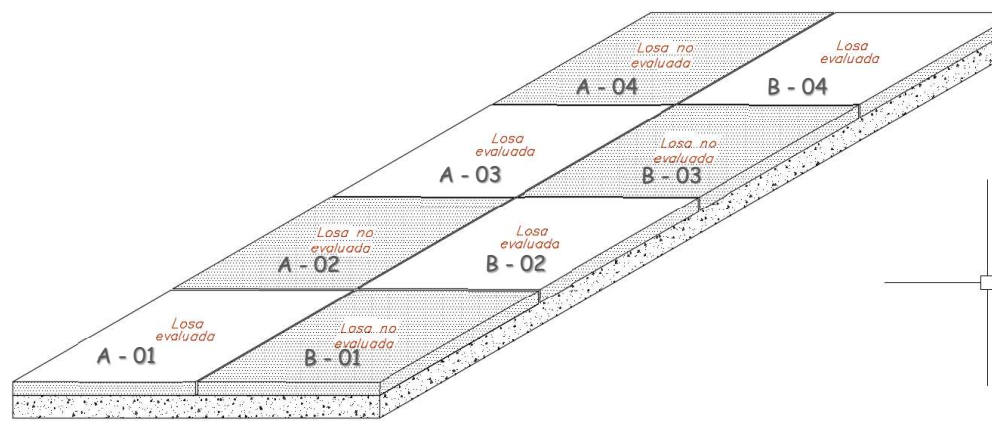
Orden de losas evaluadas para las fallas por fisuramiento.
